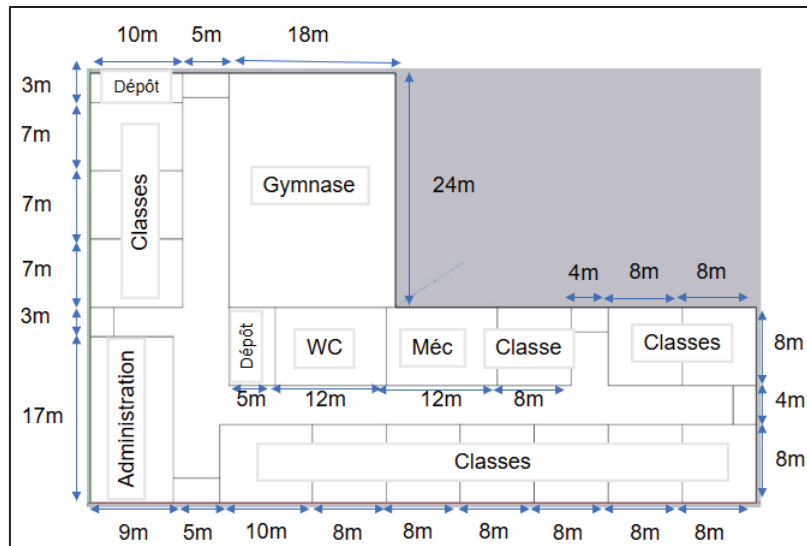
Organisation spatiale du rez-de-chaussée de l'archétype
